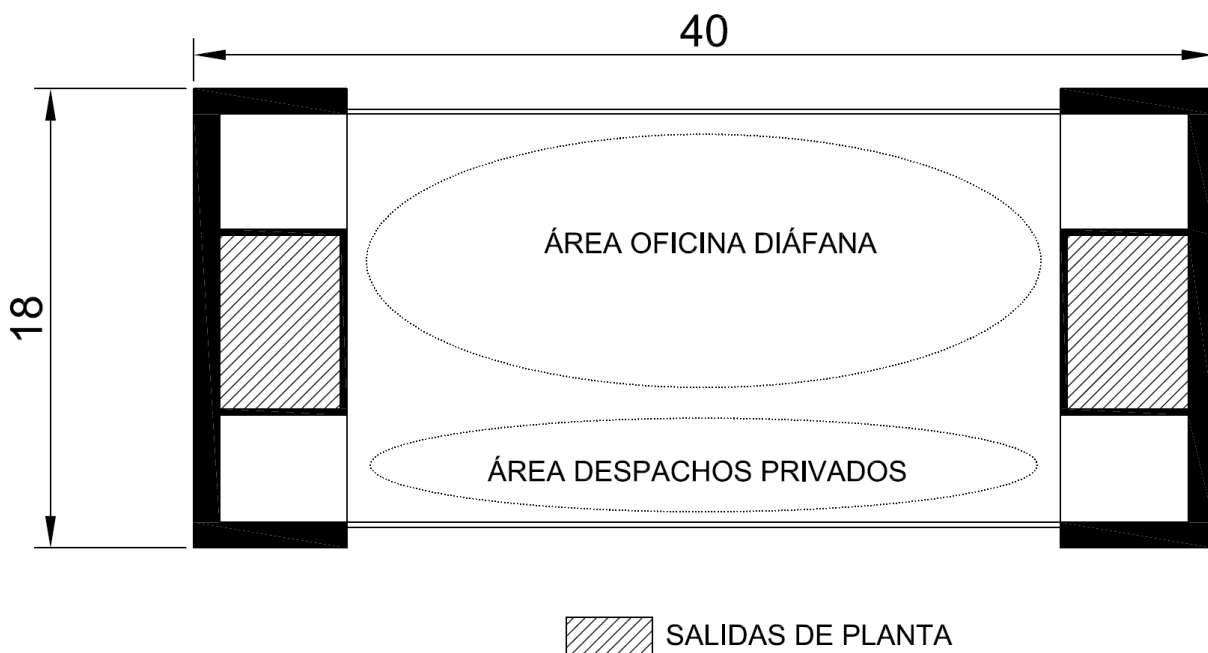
Propuesta de dimensiones de planta tipo de oficinas
